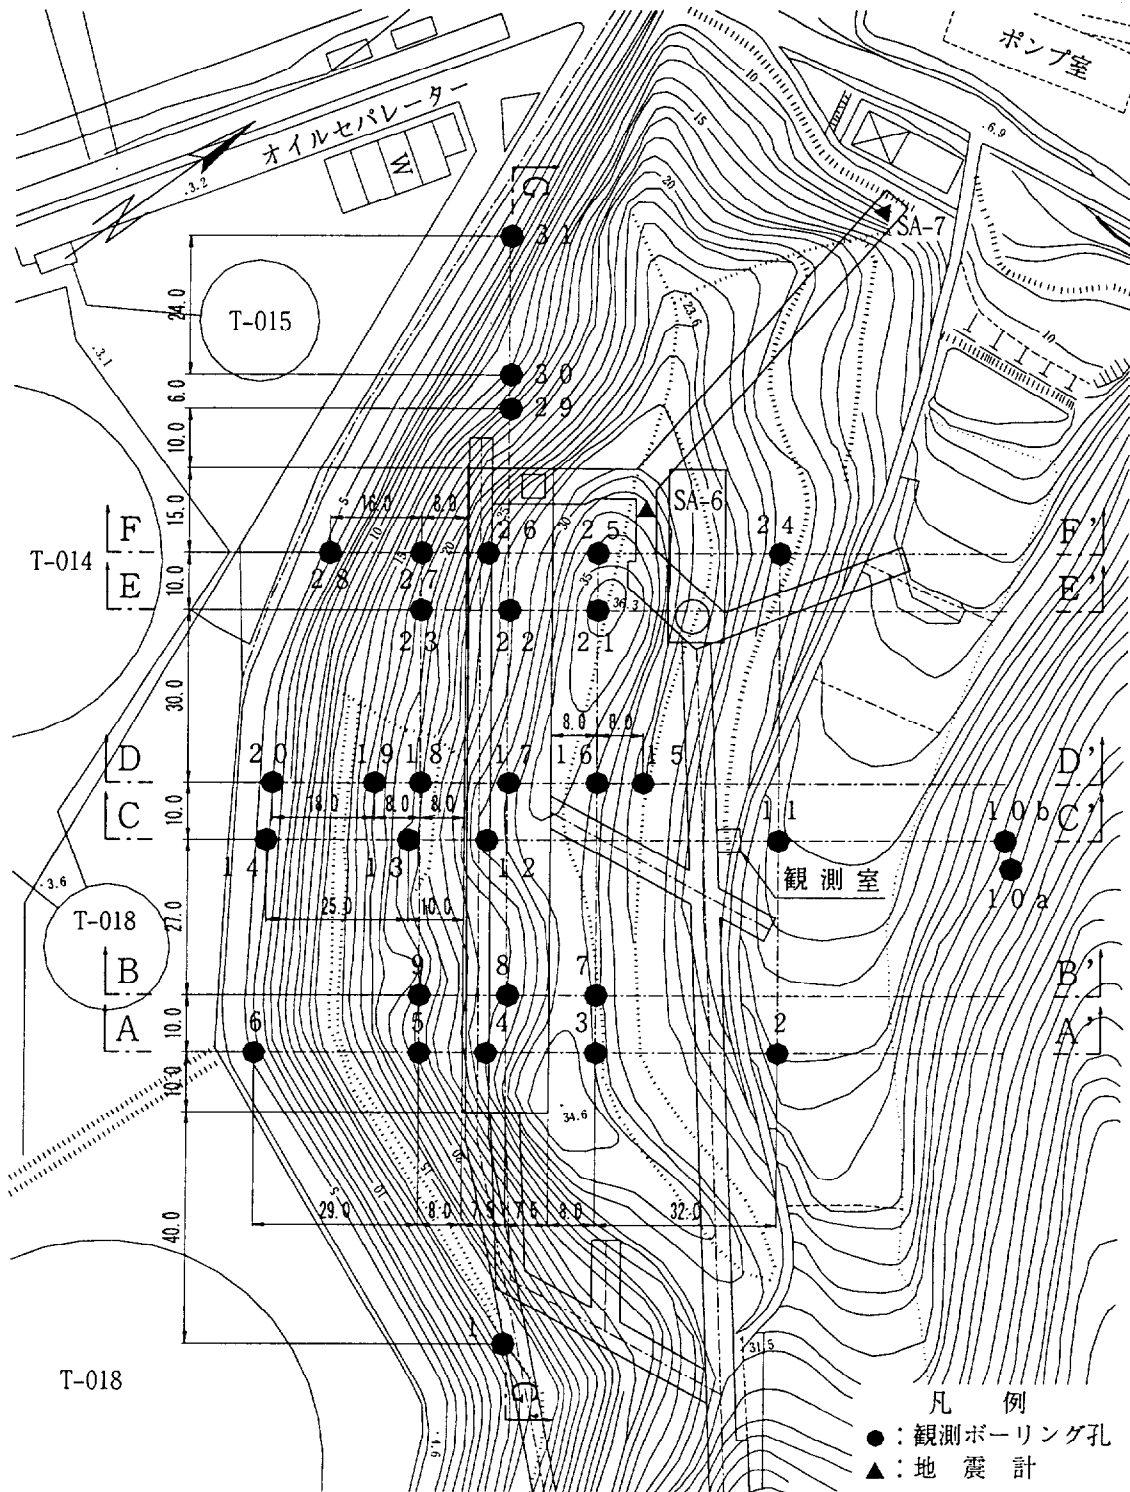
観測ボーリング孔平面配置図 14)を加筆修正
